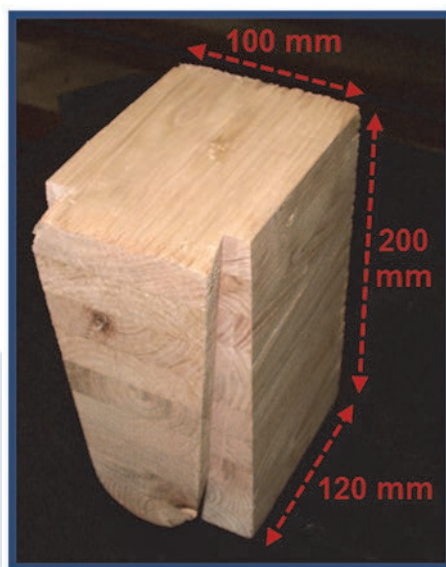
Probeta de madera laminada de castaño de sección de vigueta con espiga tallada en un extremo
